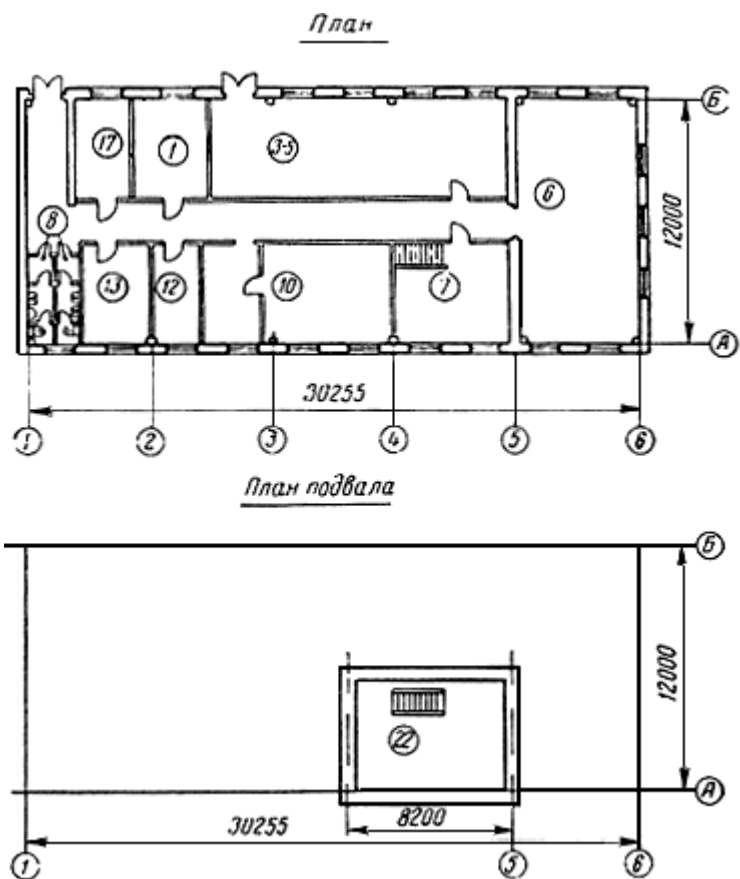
Схематический план помещений лаборатории типа I для строительства гидроузлов с объемом бетонных работ до 300 тыс. м^3
